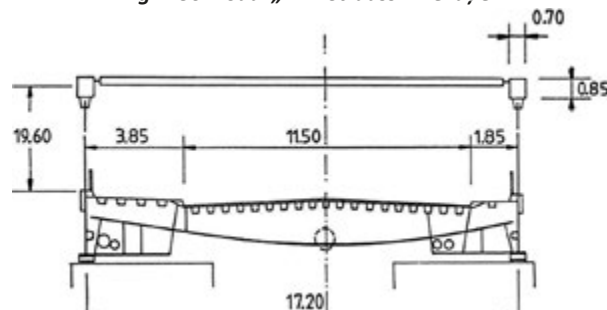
Podul „Fr. J. Strauss”. Secțiune transversală
